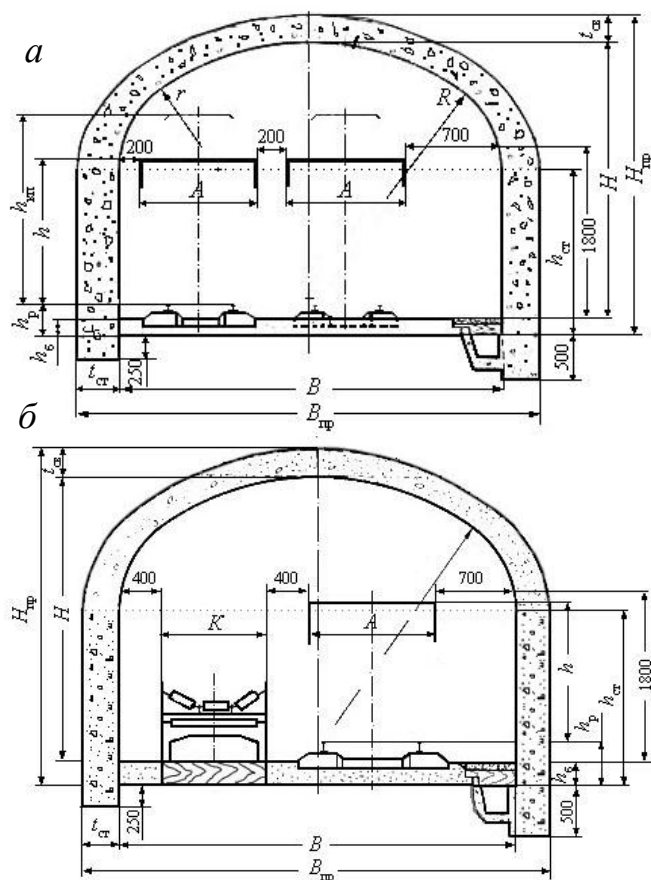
Поперечные сечения выработок с монолитной бетонной крепью и трехцентровым сводом:
